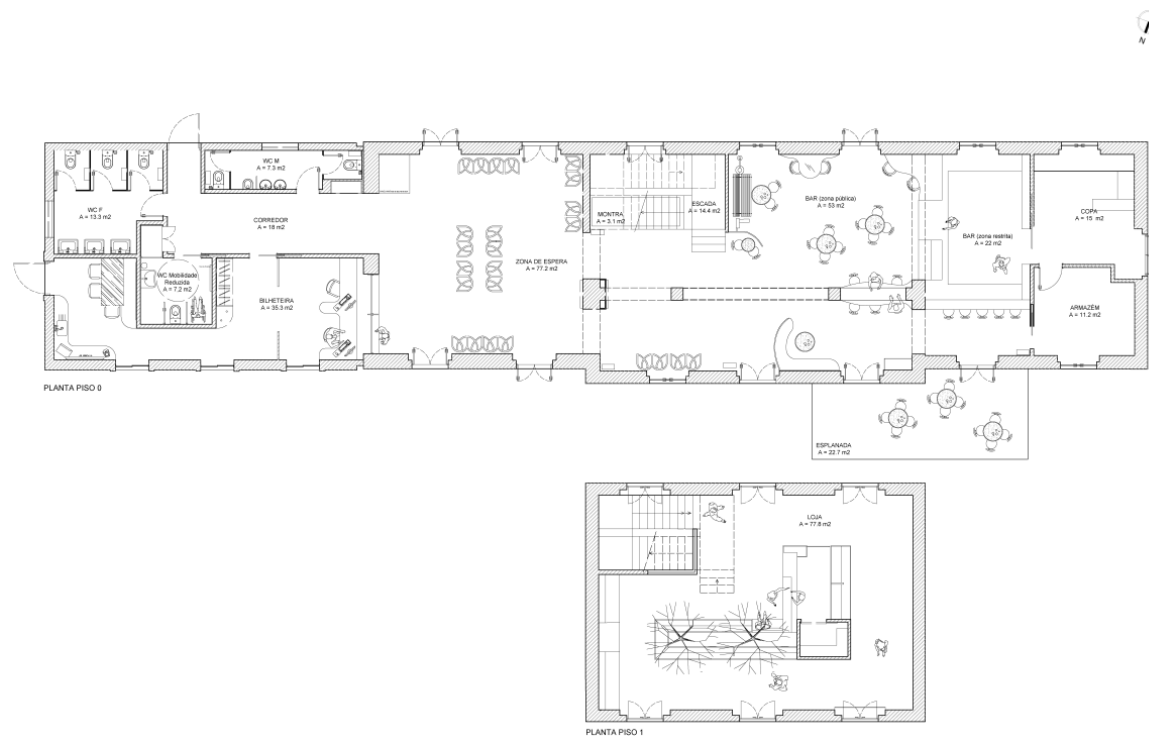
Planta de Zonamentos, Piso 0 e Piso 1
